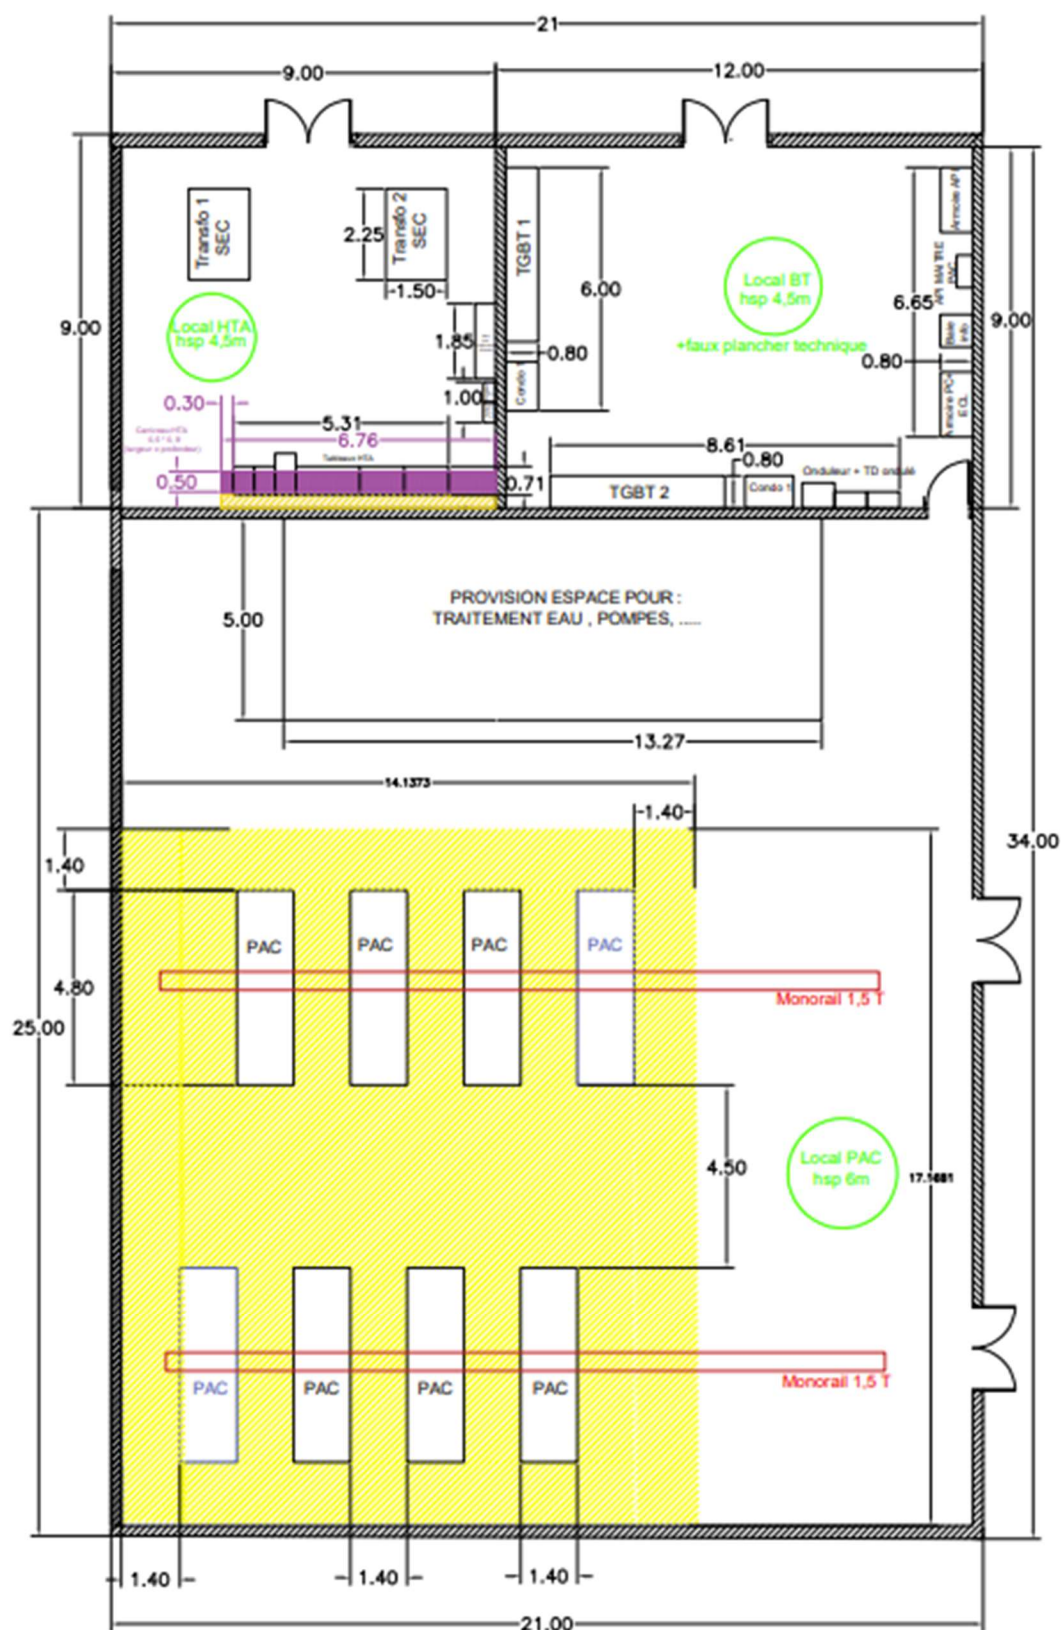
Proposition d'implantation sur la base du plan de masse fourni par Data Hills - Côtes en mètre (m)
